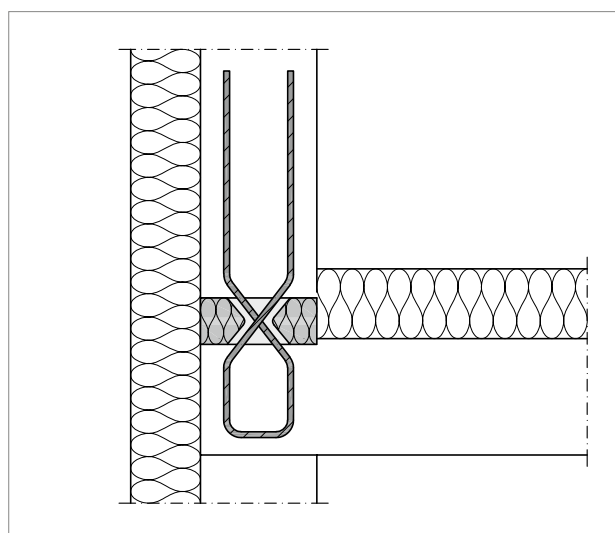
Schöck Sconnex® type W-N-VH : mur extérieur ; isolation sur la dalle selon la coupe C-C
